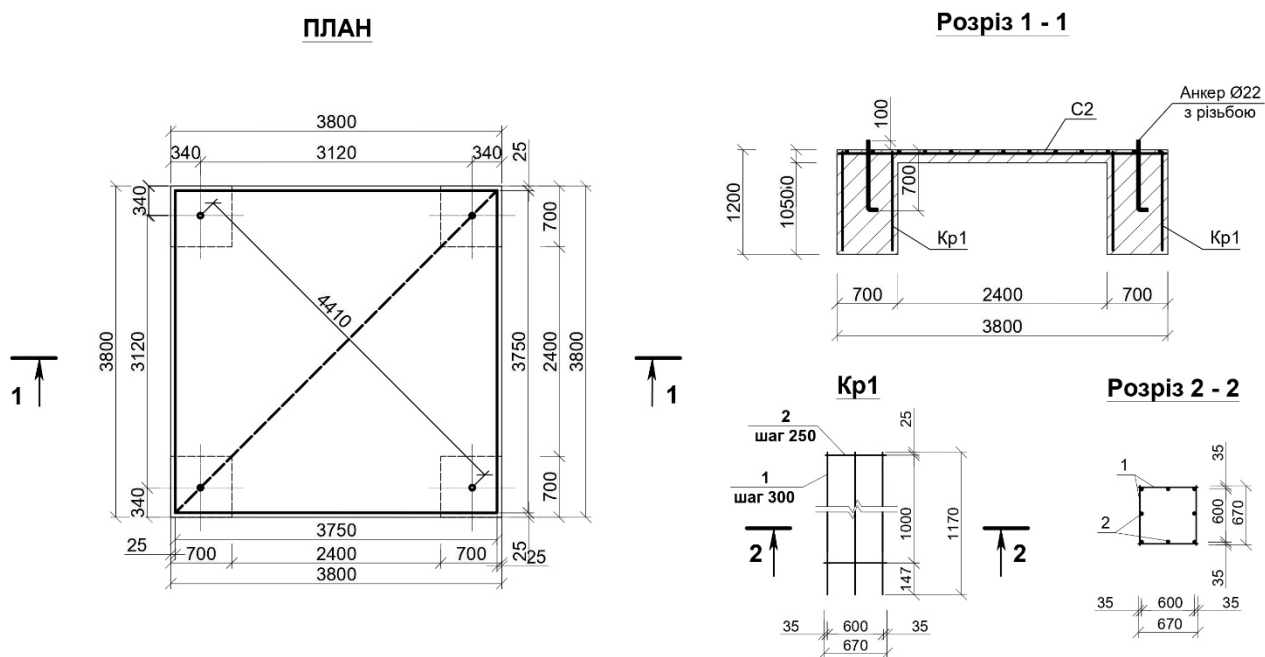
Монтажна схема бетонування опорної плити
